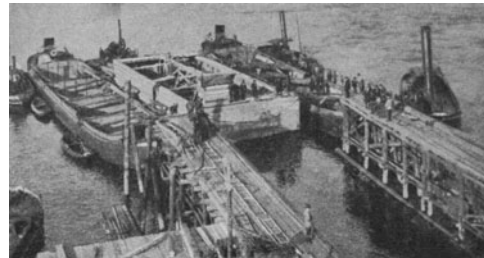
Einschleppen eines Eisenbetondruckkastens in das Versenkgerüst. (Dyckerhoff & Widmann.)
